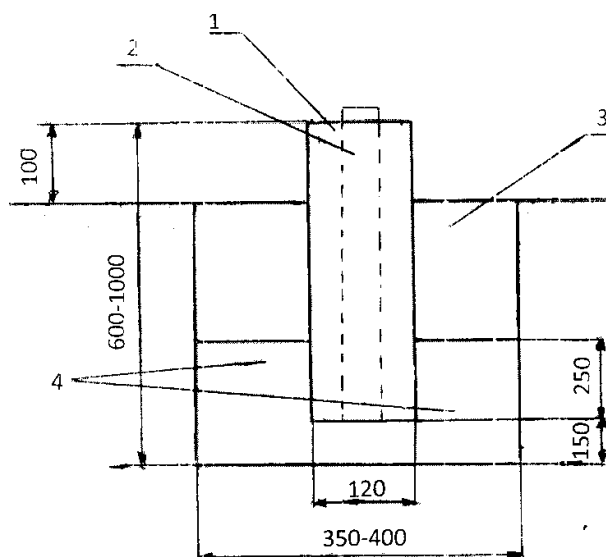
Бетонний фундамент для монтажу аркової плівкової теплиці:
